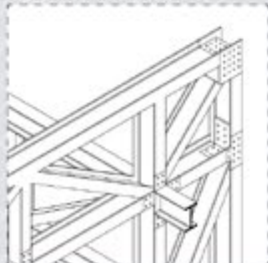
Catálogo de elementos constructivos del proyecto y exploración constructiva.
